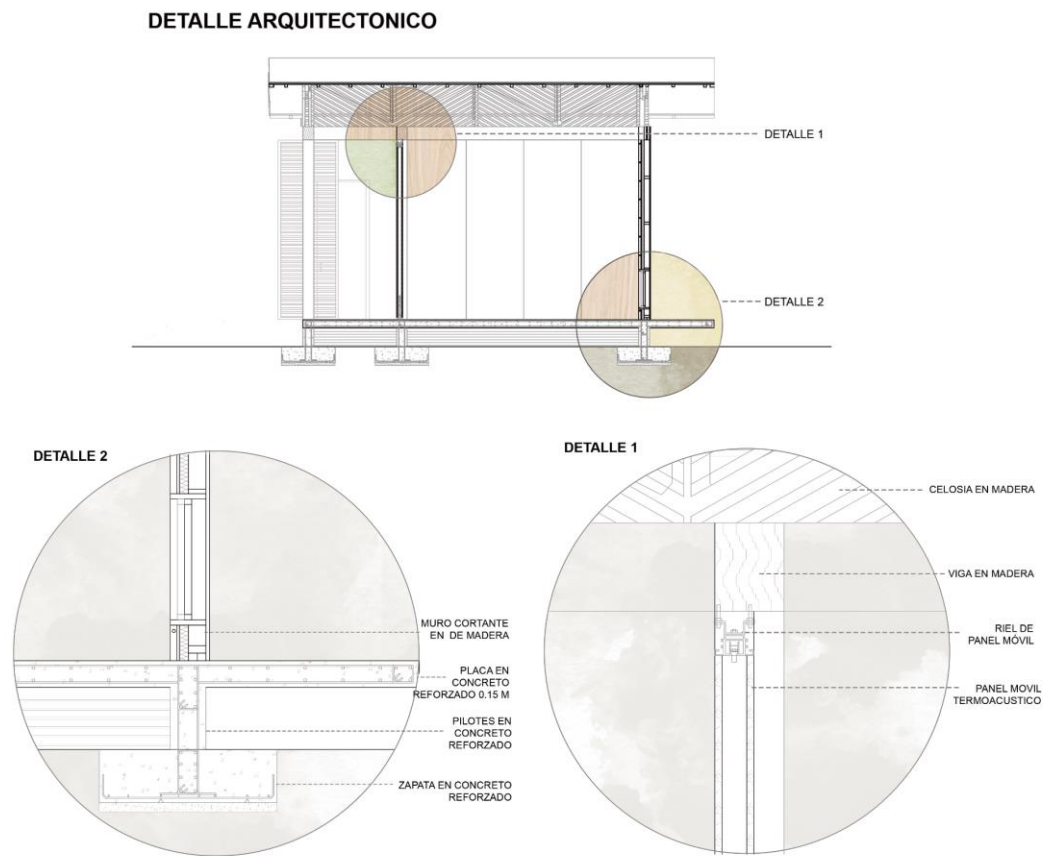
Detalles arquitectónicos. Elaboración propia.
